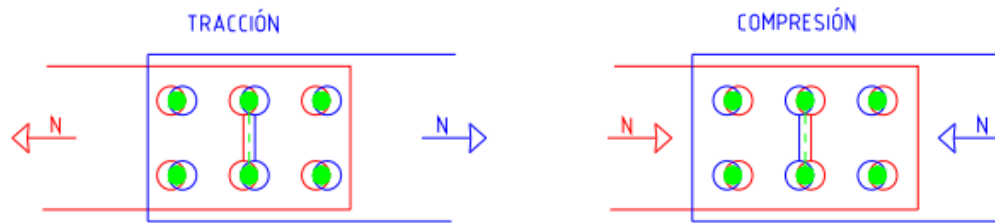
Plano de deslizamiento. [Gentileza de Ulma Construction]
